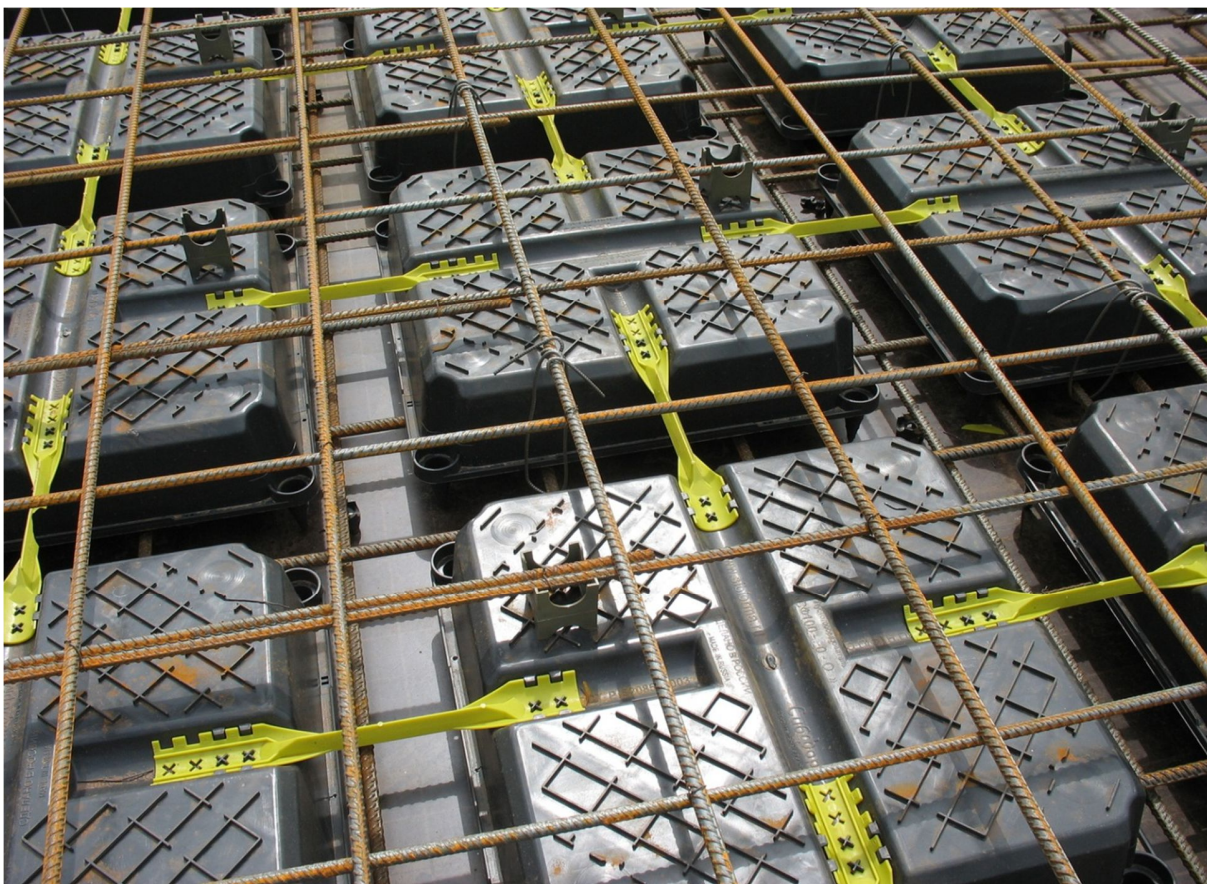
Общий вид несъемной опалубки, установленной на внешней опалубке и смонтированным нижним и верхним армированием плиты (до укладки бетонной смеси)
